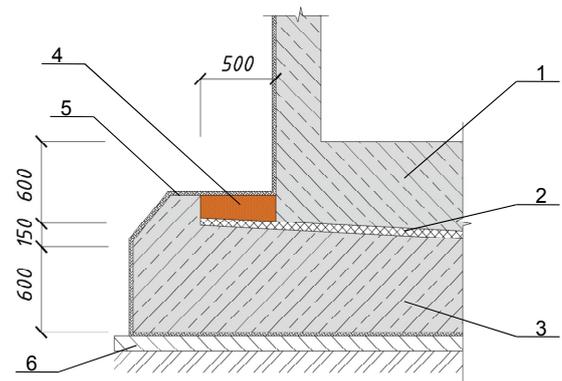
Схема сейсмоизолирующего скользящего пояса: 1 – нижняя часть здания в уровне фундамента; 2 – фторопластовые пластины; 3 – фундамент; 4 – песок крупный (демпфер); 5 – гидроизоляция; 6 – бетонная подготовка пола
